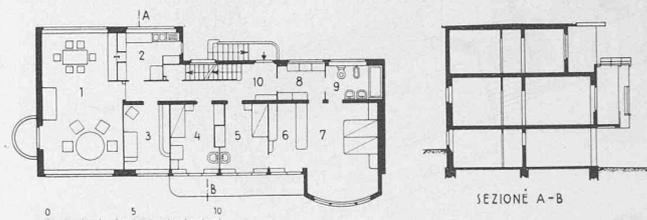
Grundriss und Schnitt 1 : 400 des Landhauses am Langensee
